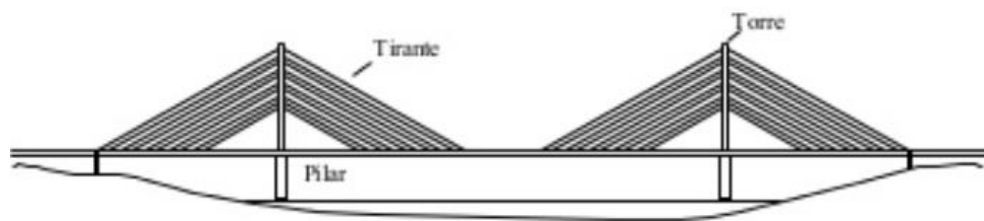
Puente atirantado. Fuente: Guía para el diseño de puentes con vigas y losas.
